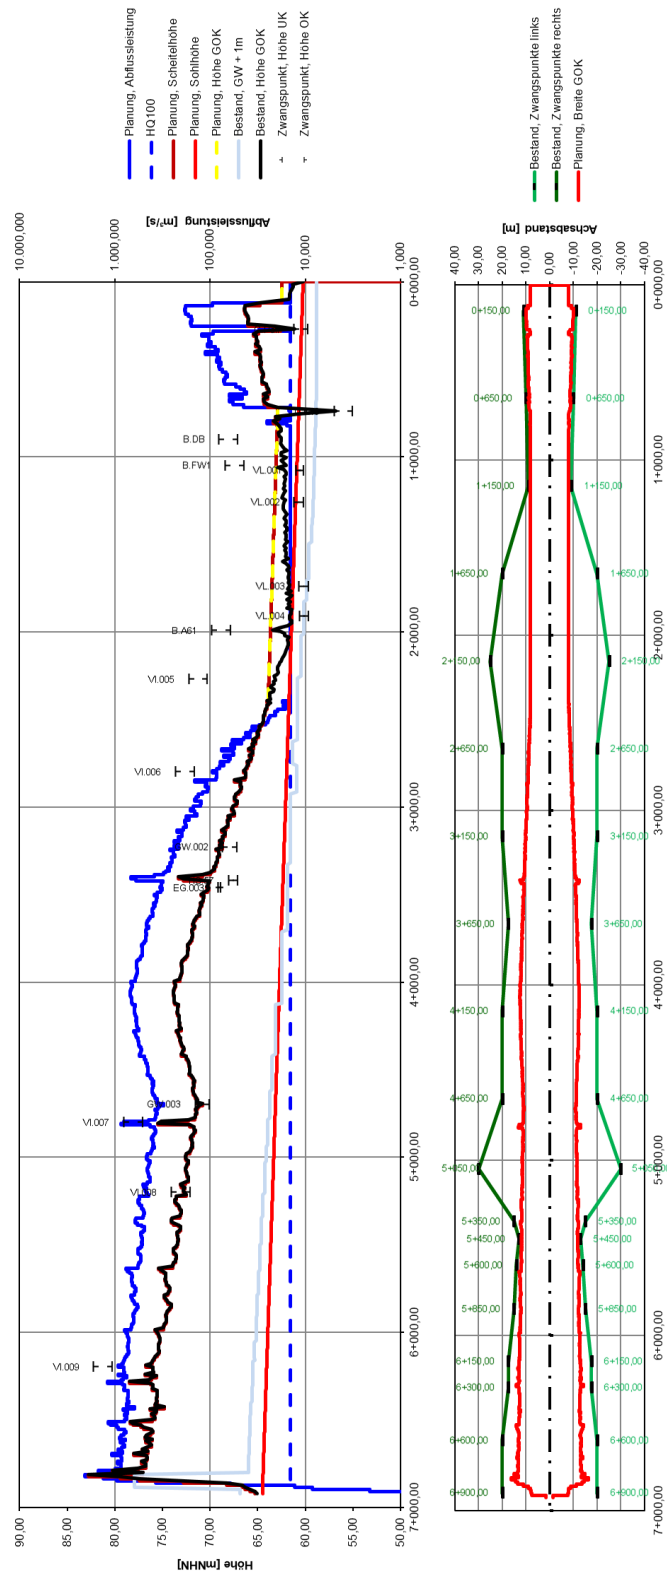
Längsschnitt (links) und Grundriss (rechts) der Variante Hambachbahn (4.3) (vgl. Anlage A-5.3).
